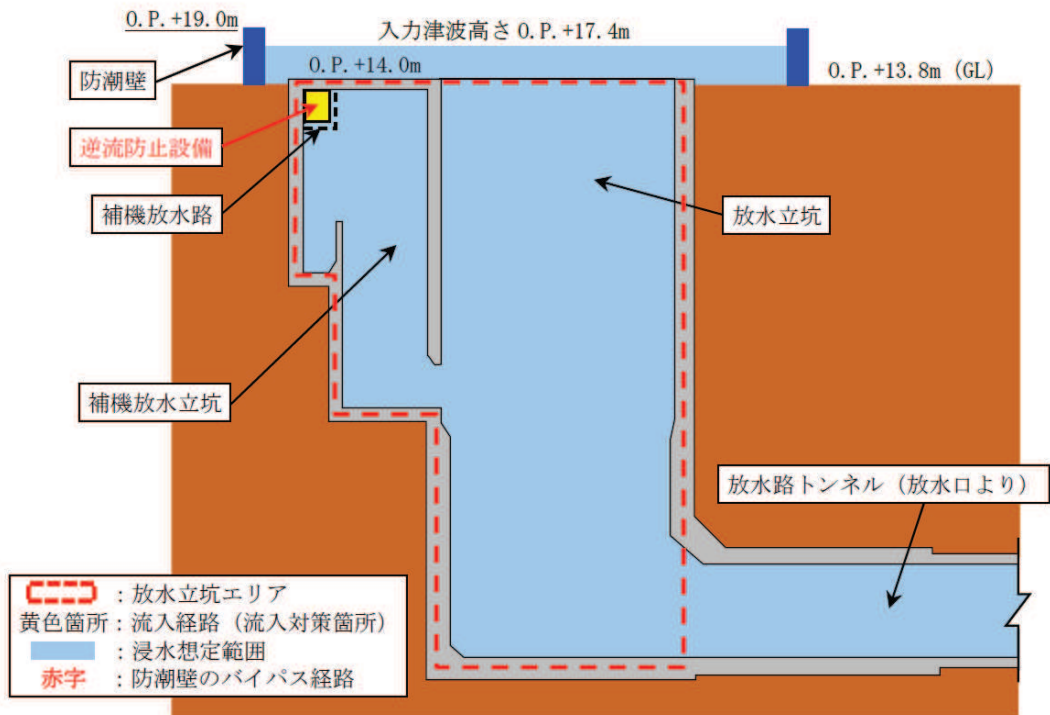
第 2 号機 放水立坑 流入対策配置図 (A-A 断面図)
